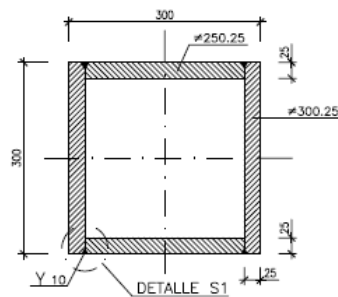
Detalle del perfil de la viga cajón del mirador.
